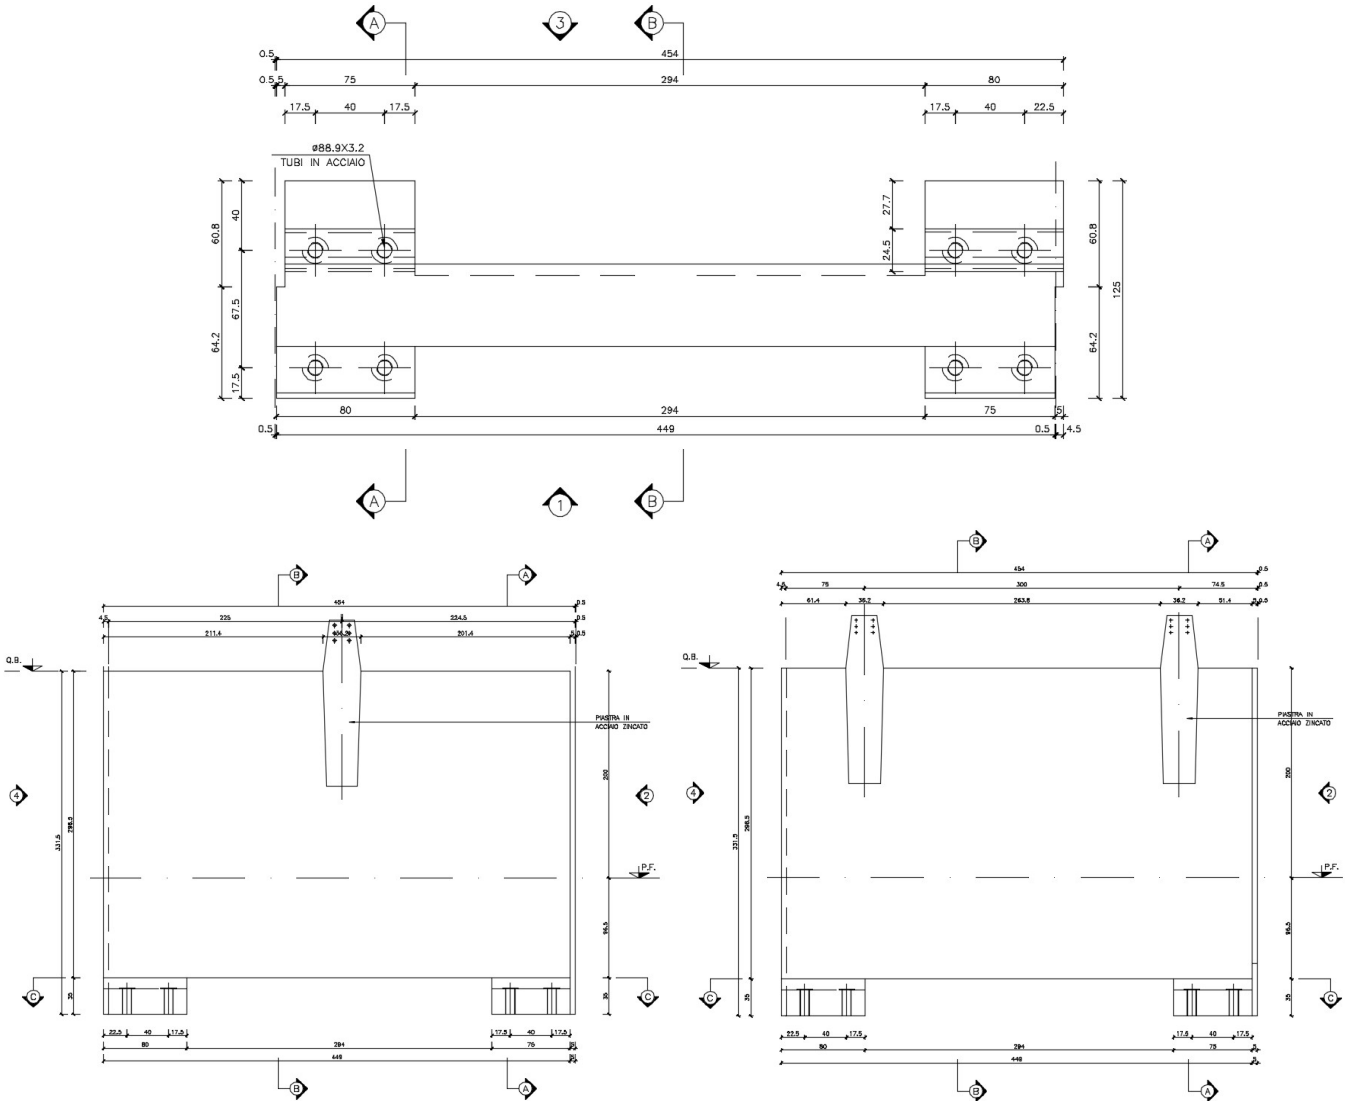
Pianta e prospetto modulo di scavalco BS145-450
